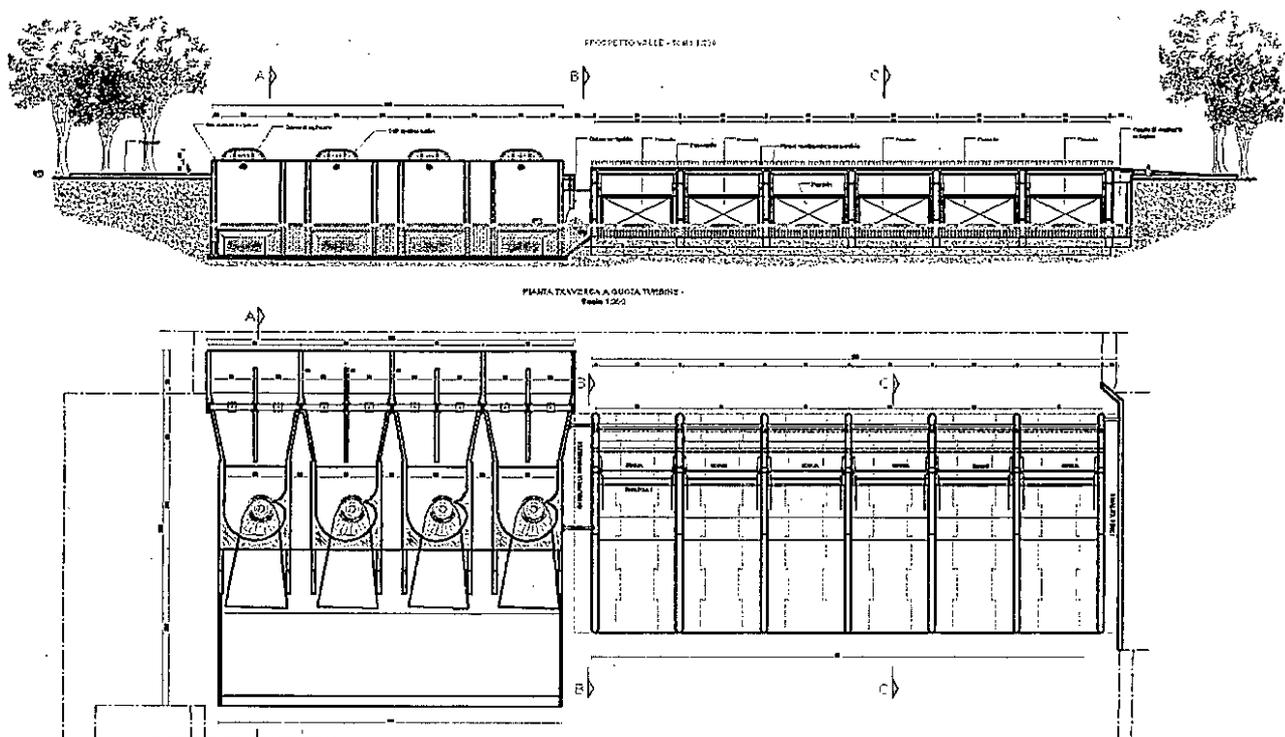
Variante progettuale: prospetto di valle e planimetria a quota turbine della centrale idroelettrica
